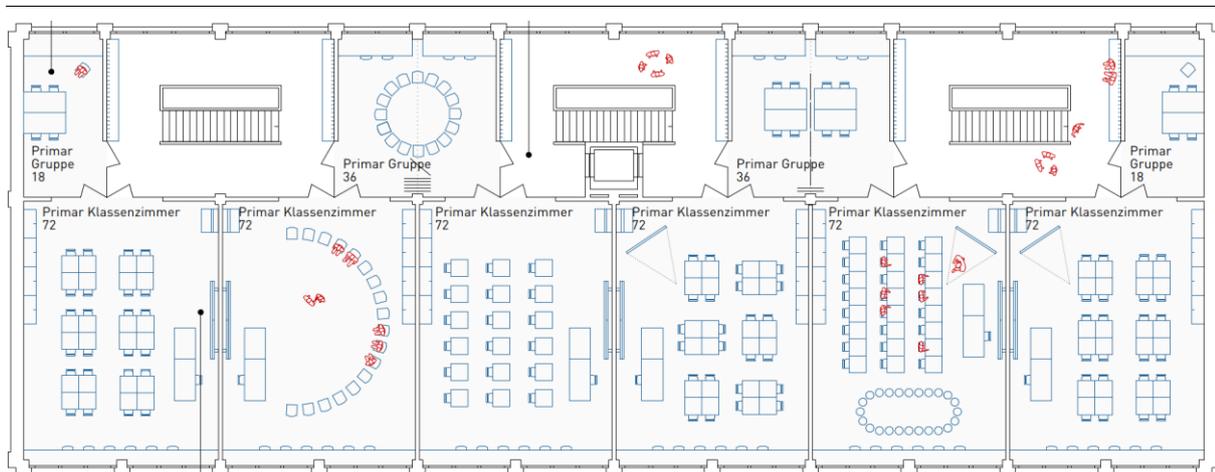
Grundriss Obergeschoss Primar Neubau
